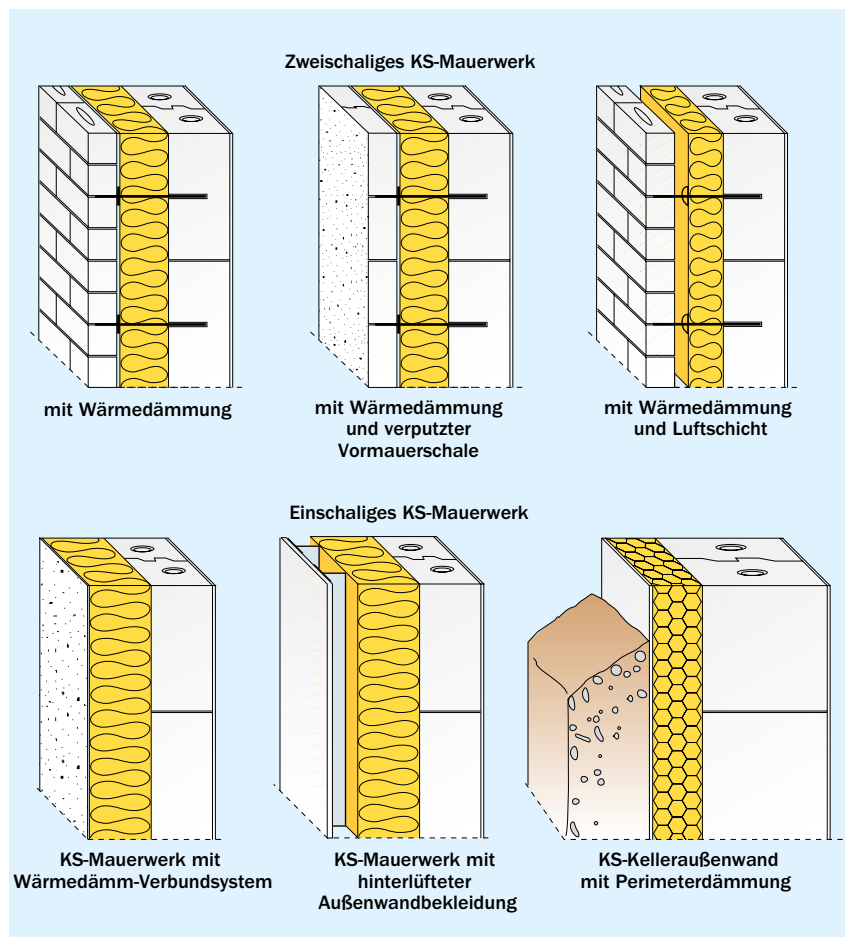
KS-Außenwandkonstruktionen für beheizte Gebäude
